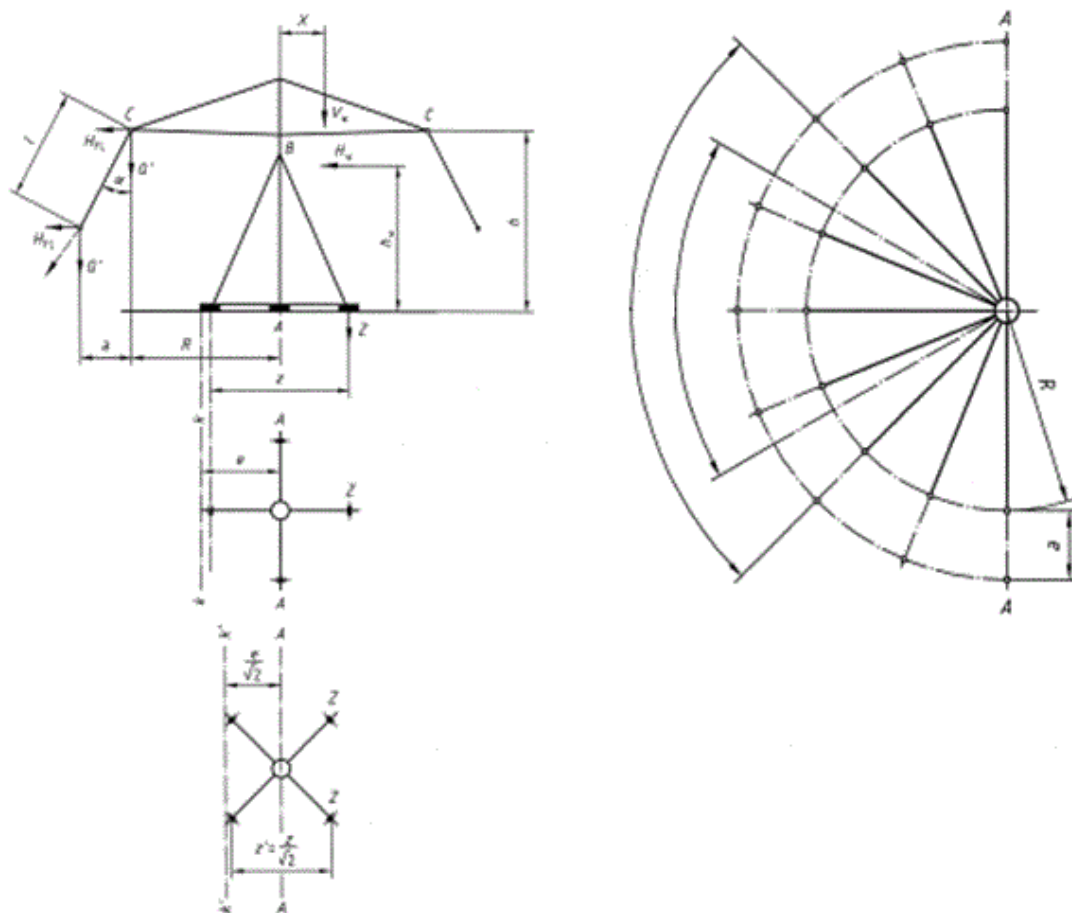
Przykłady przygotowania fundamentu i posadowienia.
